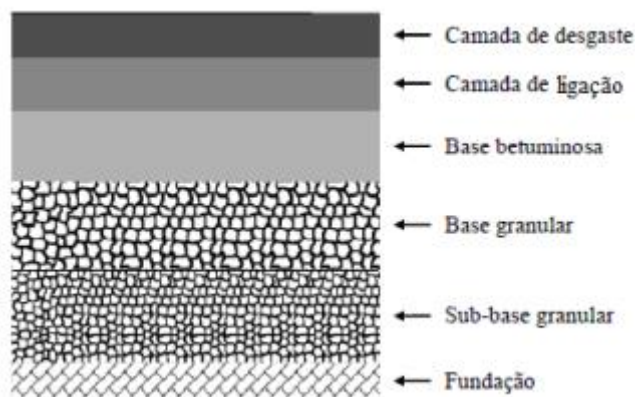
Pavimento Flexível (Pereira, 2014)
